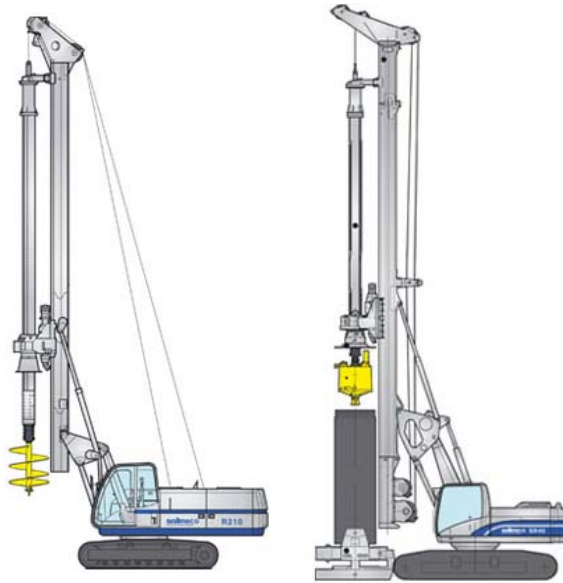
Equipamentos de execução de estacas - Furação e Cravação – Fonte: Soilmec
